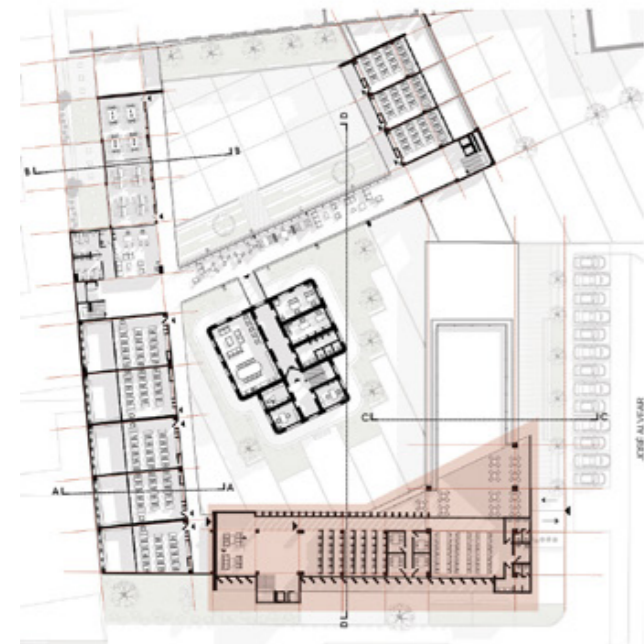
Esquema Planta alta | Fuente: Elaboración propia
